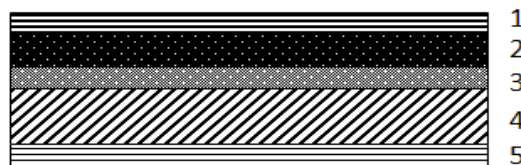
Coupe vertical d'un plancher du balcon.
